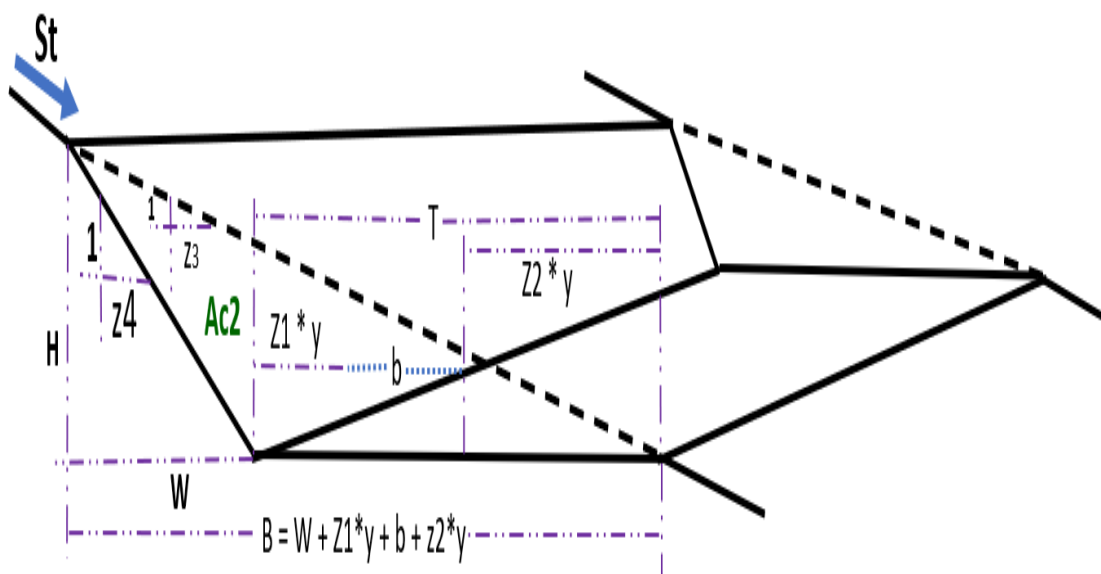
Área de corte 2 “Ac2” para una acequia de ladera trapezoidal
